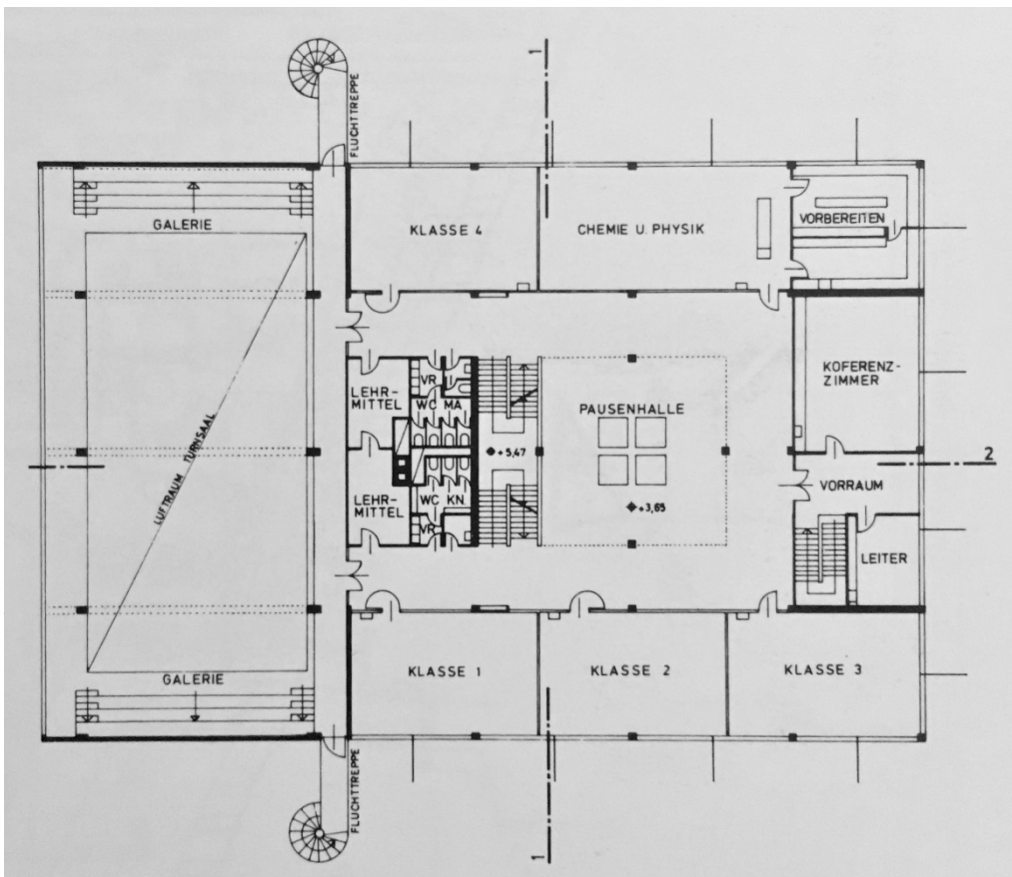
Hauptschule Mauer Öhling, Grundriss 1. Obergeschoss, 1976
